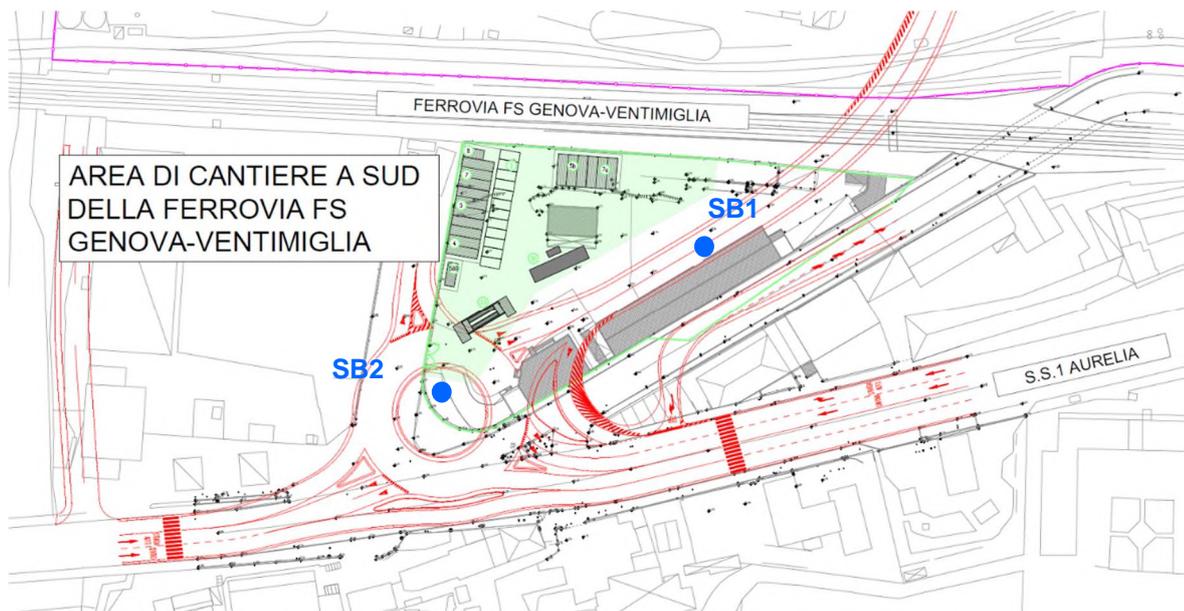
Ubicazione indagini geognostiche eseguite e sovrapposizione sulla planimetria di progetto
